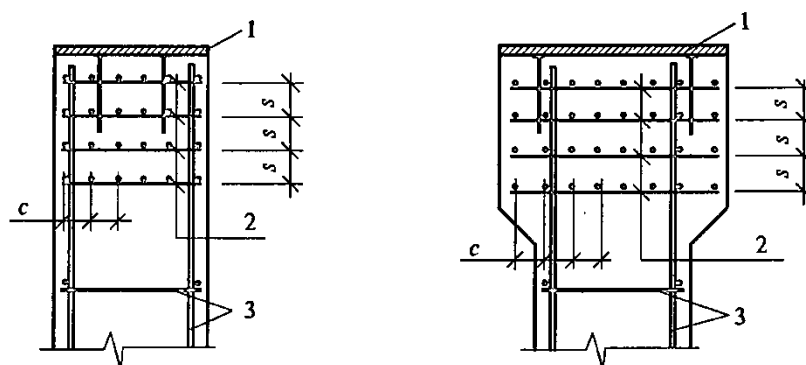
Армирование оголовков колонн: а) конструкция оголовка без уширения опорной части; б) конструкция оголовка с уширением опорной части;
